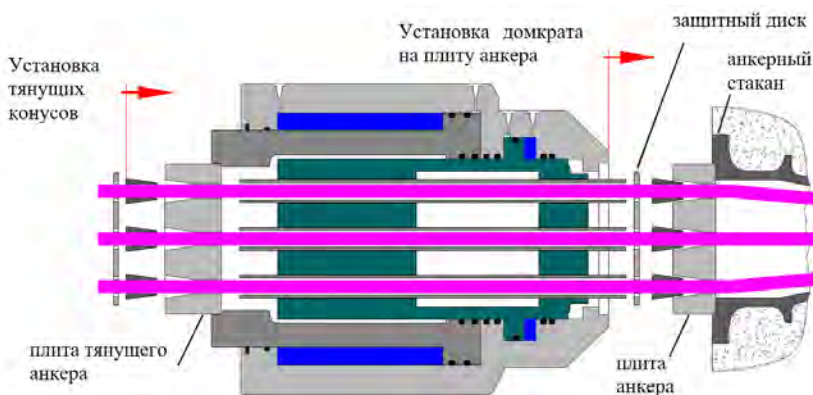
Схема монтажа гидравлического домкрата на арматурный пучок
